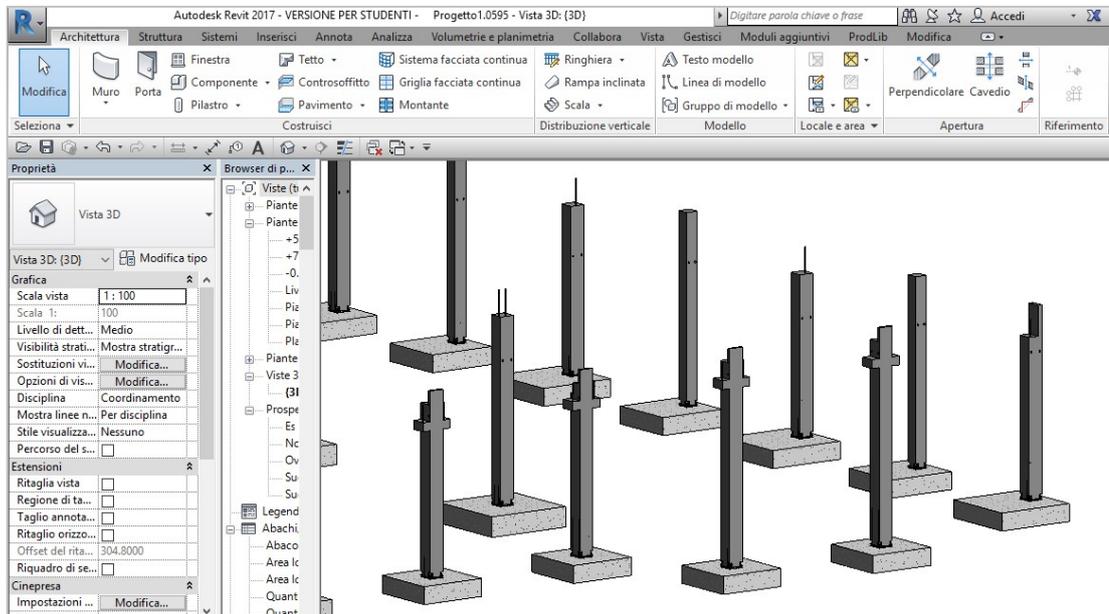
Realizzazione pilastri prefabbricati a sezioni diverse e posizionamento; vista 3D di Revit.
